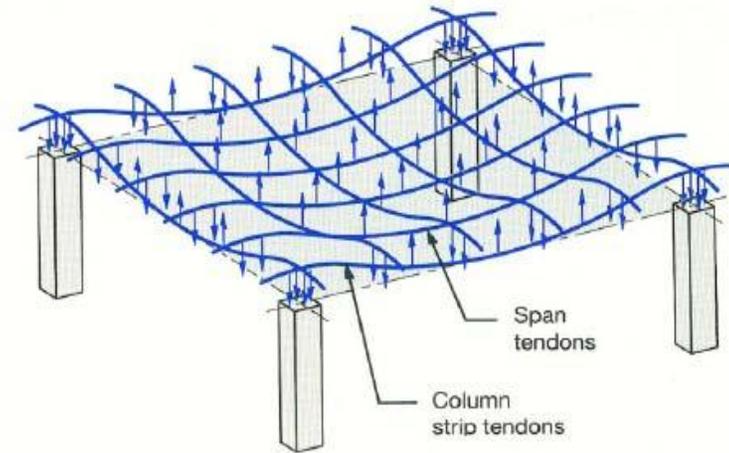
DETALLE DE LOSA POSTENSADA. ISOMÉTRICO
